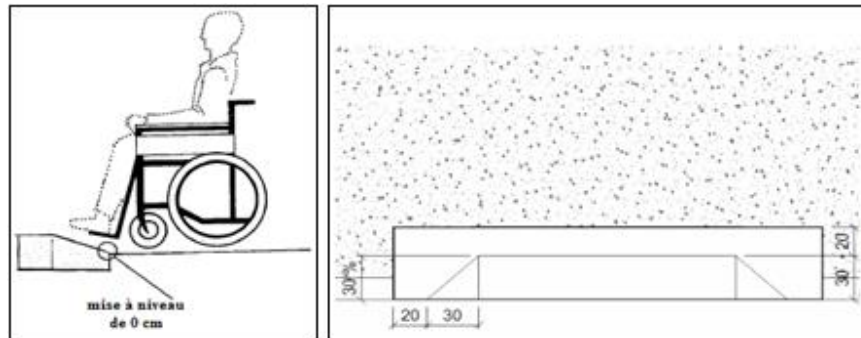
Exemple à moduler en fonction de la hauteur et de la largeur disponible du trottoir.
